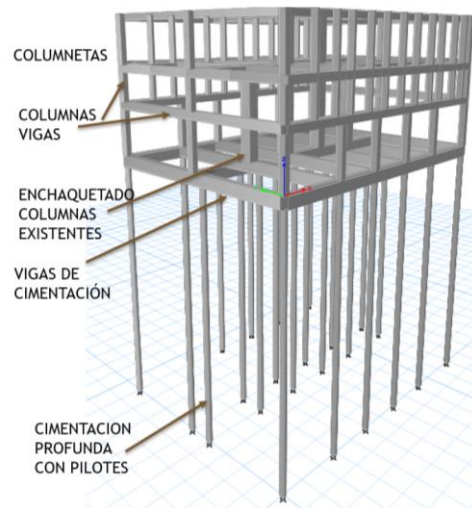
Propuesta de intervención reforzamiento interno en concreto.
